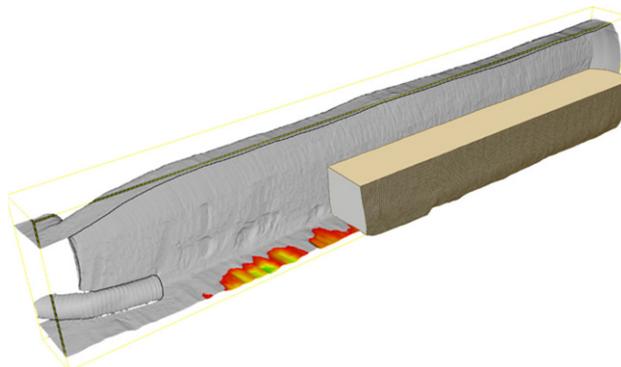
Schnittdarstellung Standortmodell mit dem Dammbauwerk
